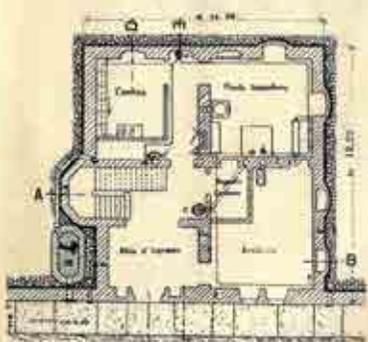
Pianta dei sotterranei (Scala 1:200)
